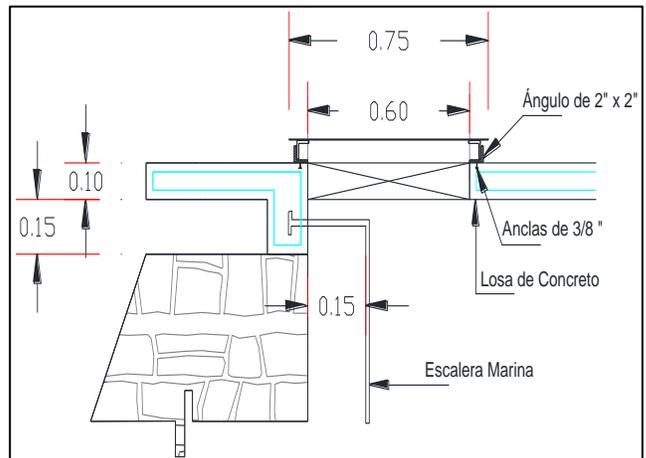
Detalle de registro en losa de cubierta en tanques de mampostería.
